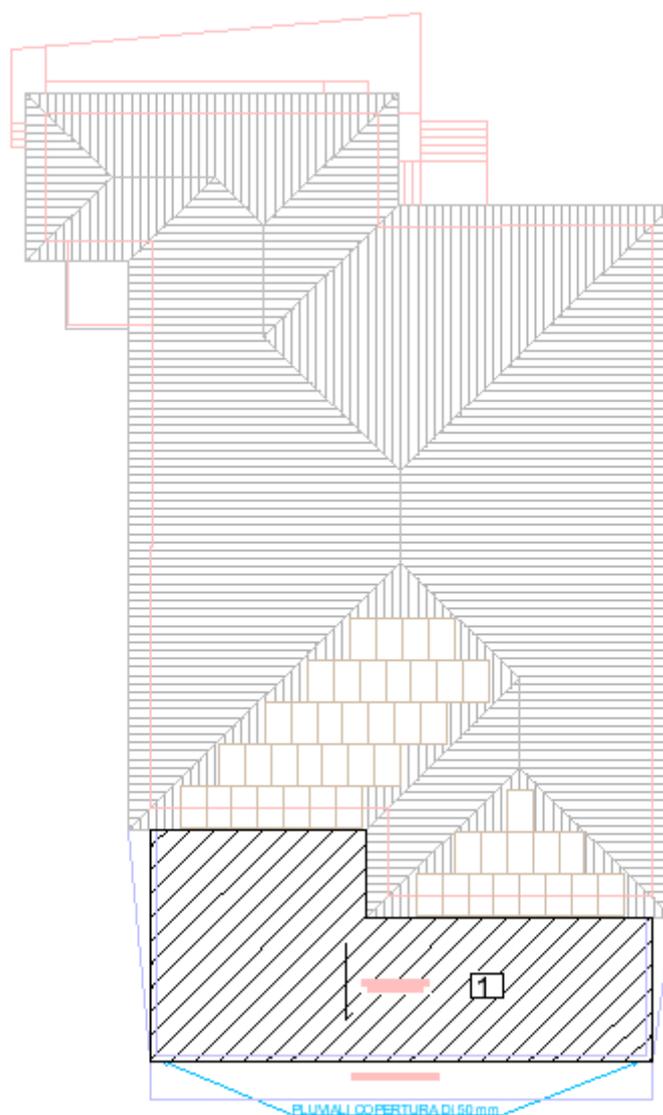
Area copertura piana con ghiaietto in progetto e disposizione discendenti
